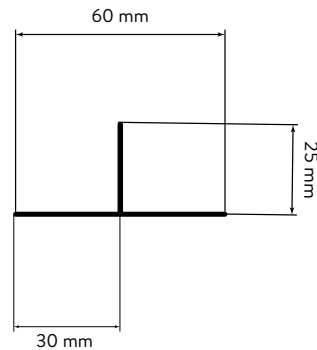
PAVE EDGE® LIGHT/LIGHTFLEX
